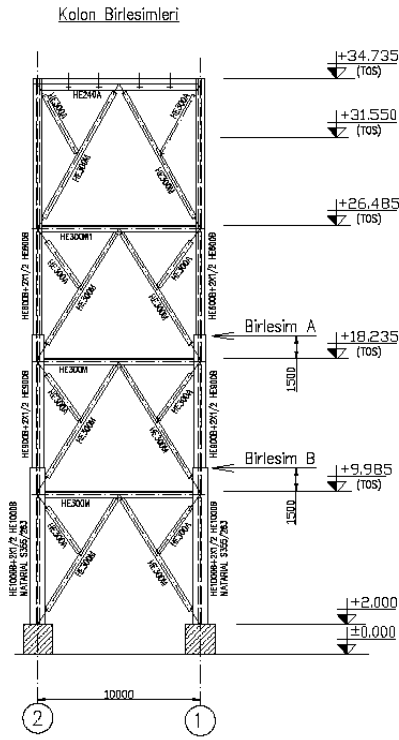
Orta Kısım Düşey Çaprazı Eleman Markalaması
